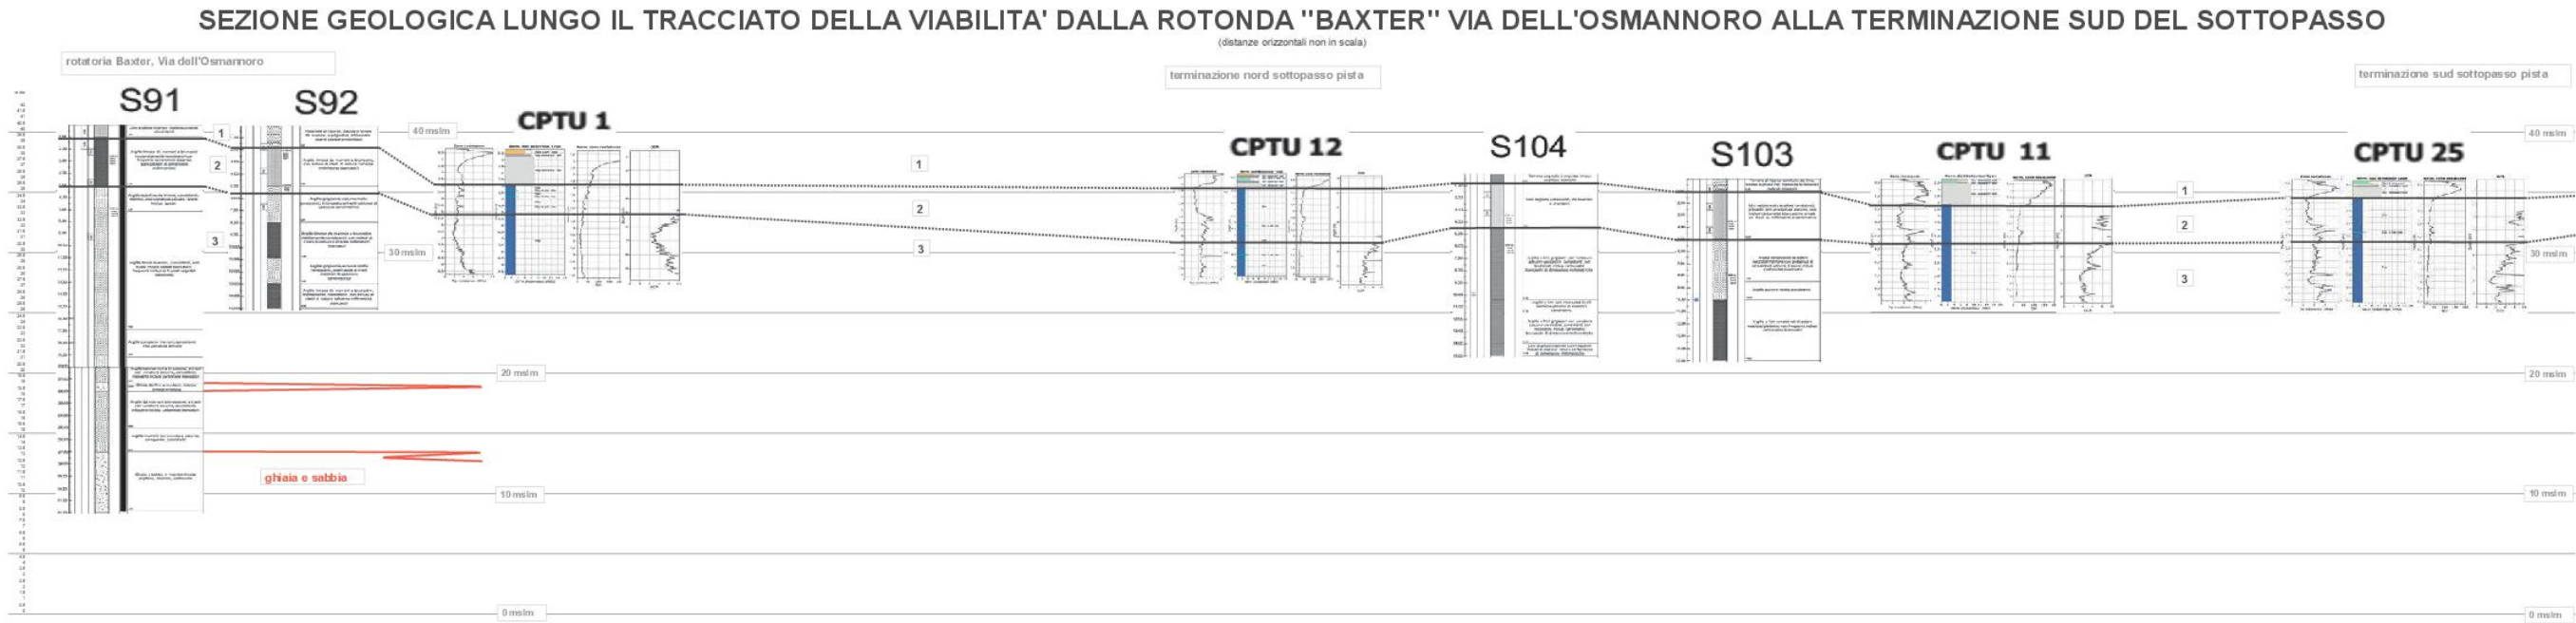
Sezione geologica tracciato viabilità dalla rotonda B “BAXTER” via dell’Osmannoro alla terminazione sud del sottoattraversamento pista.
